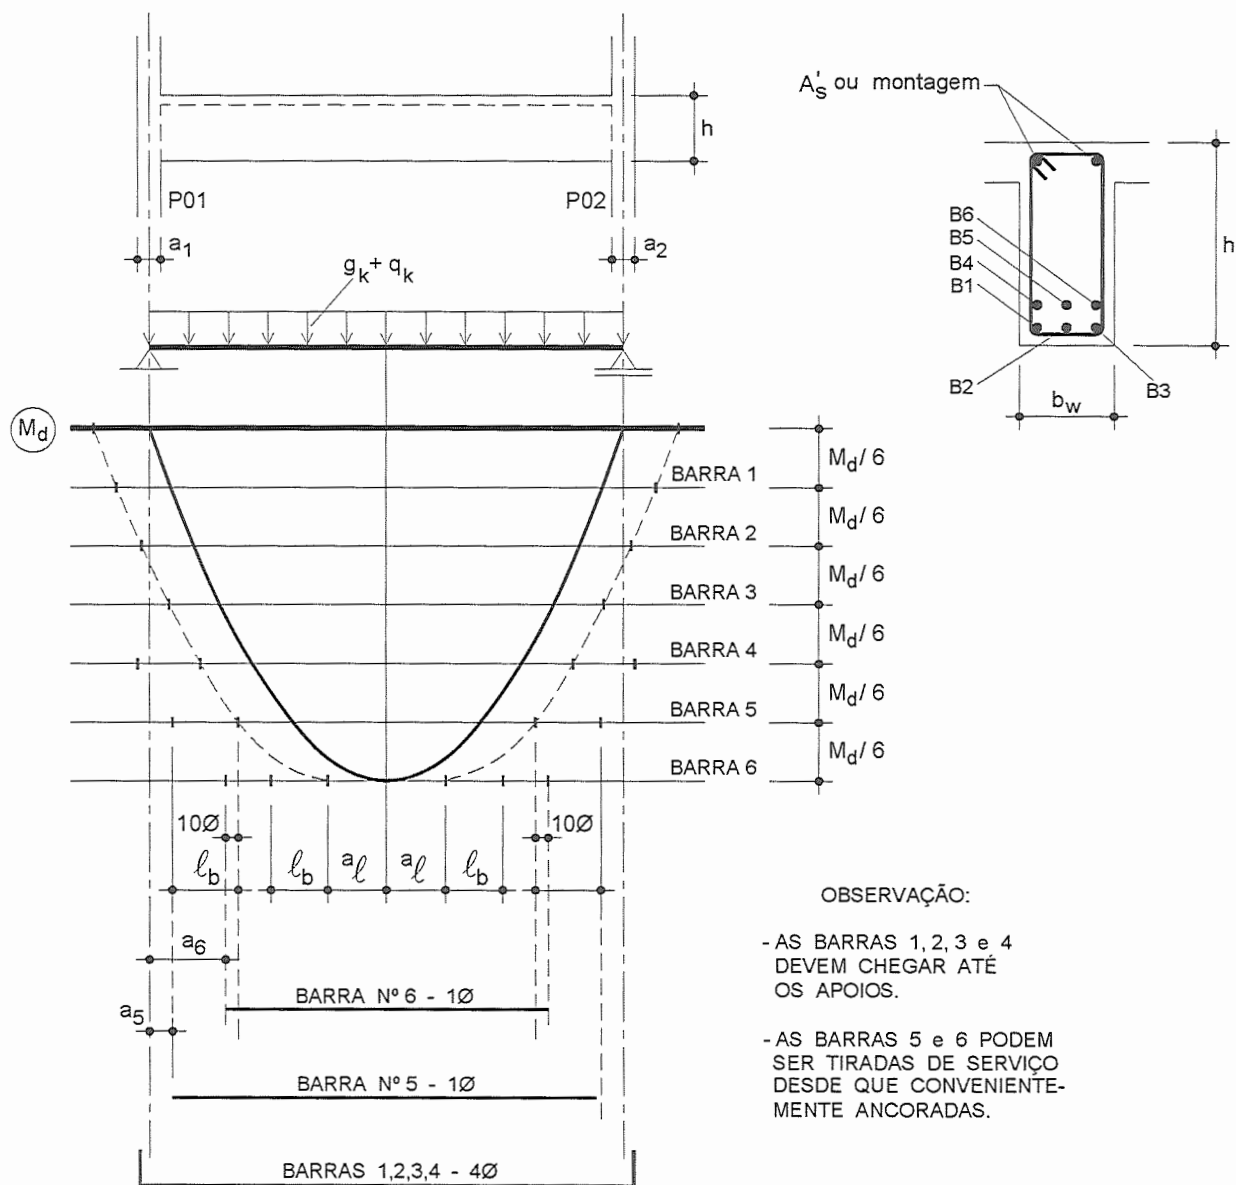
Vigas: ancoragem da armadura longitudinal.
